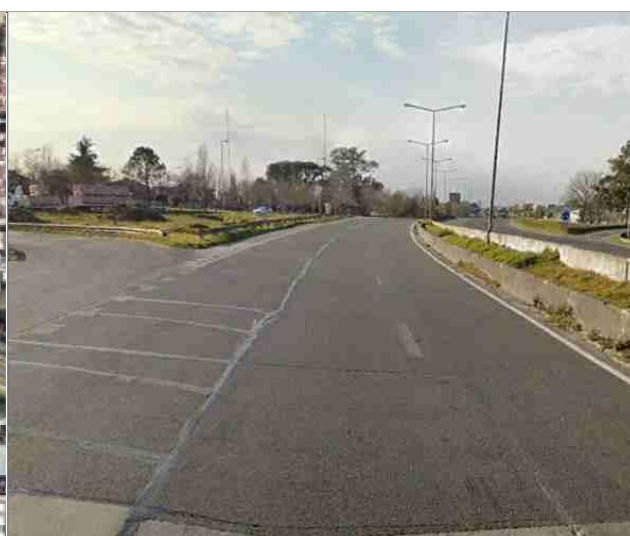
y Foto 237. Intersección RP N°6 con RN N°9
